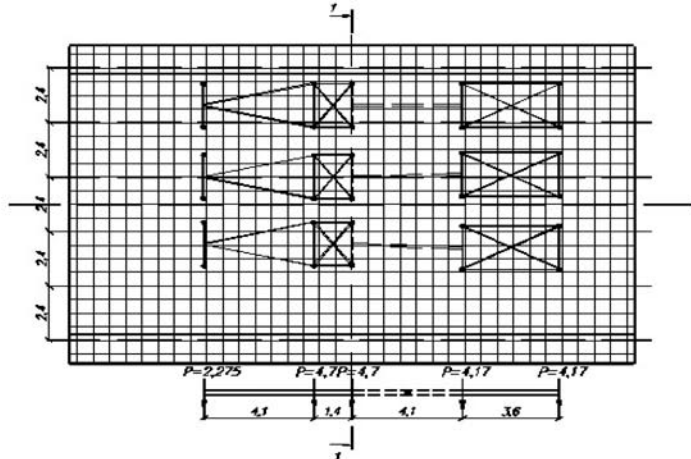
Схема расстановки нагрузки на пролетном строении путепровода
